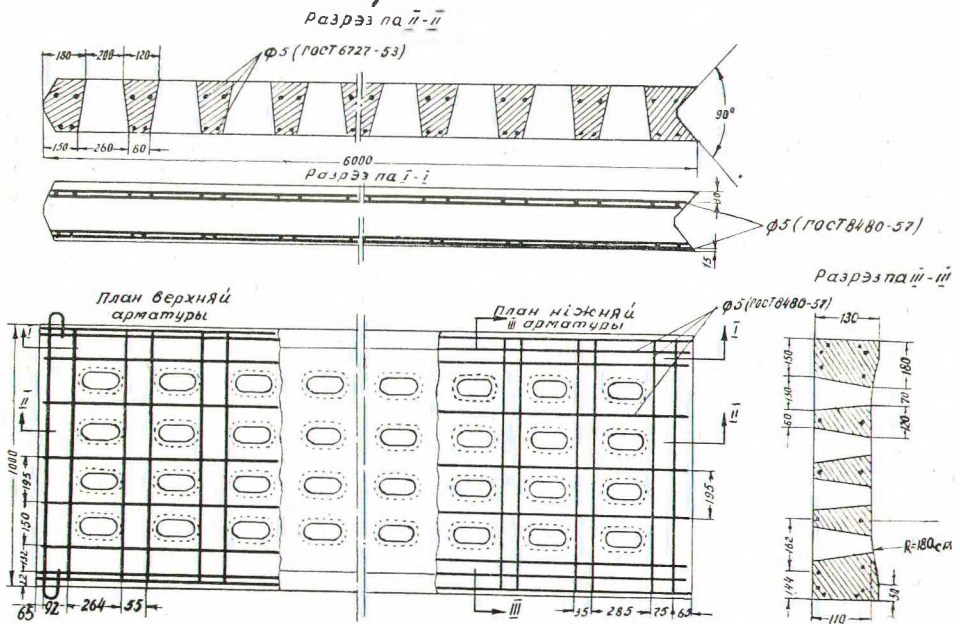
Канструкцыя жалезабетоннай пліты з папярэдне напружанай арматурай.
